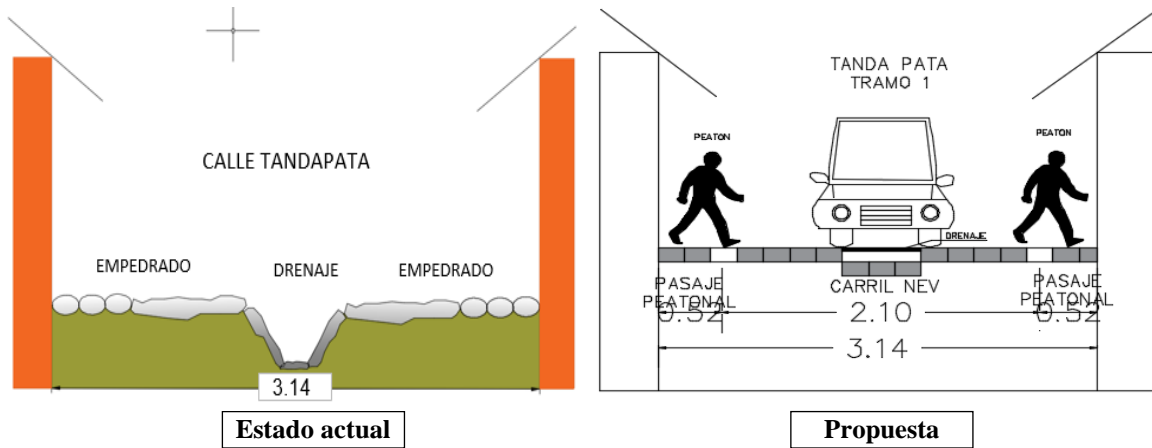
Propuesta de la sección transversal para la calle Tandapata 1
